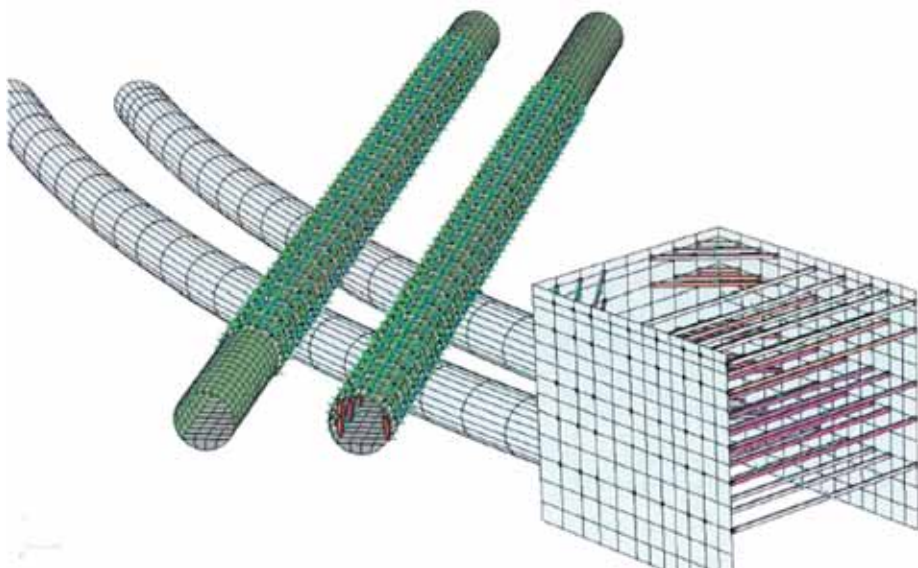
Фрагмент расчётной схемы на момент окончания строительства
